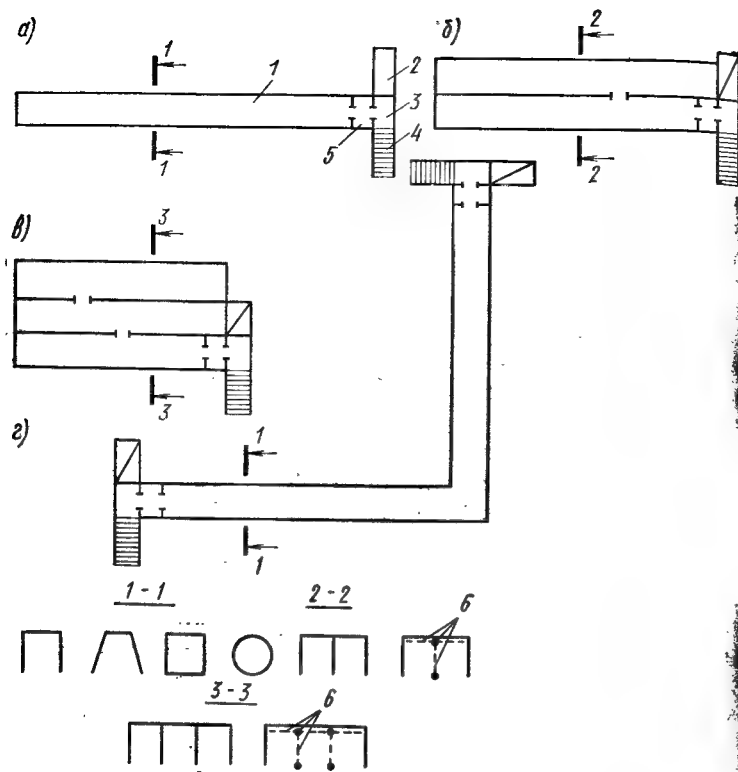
Планировочные схемы быстровозводимых убежищ
